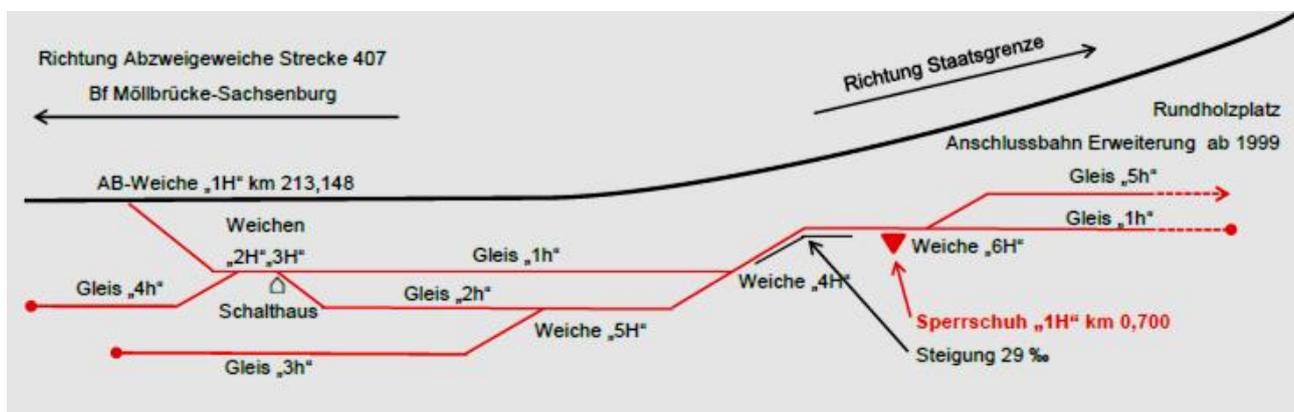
Lageplanskizze AB (Quelle SUB)
